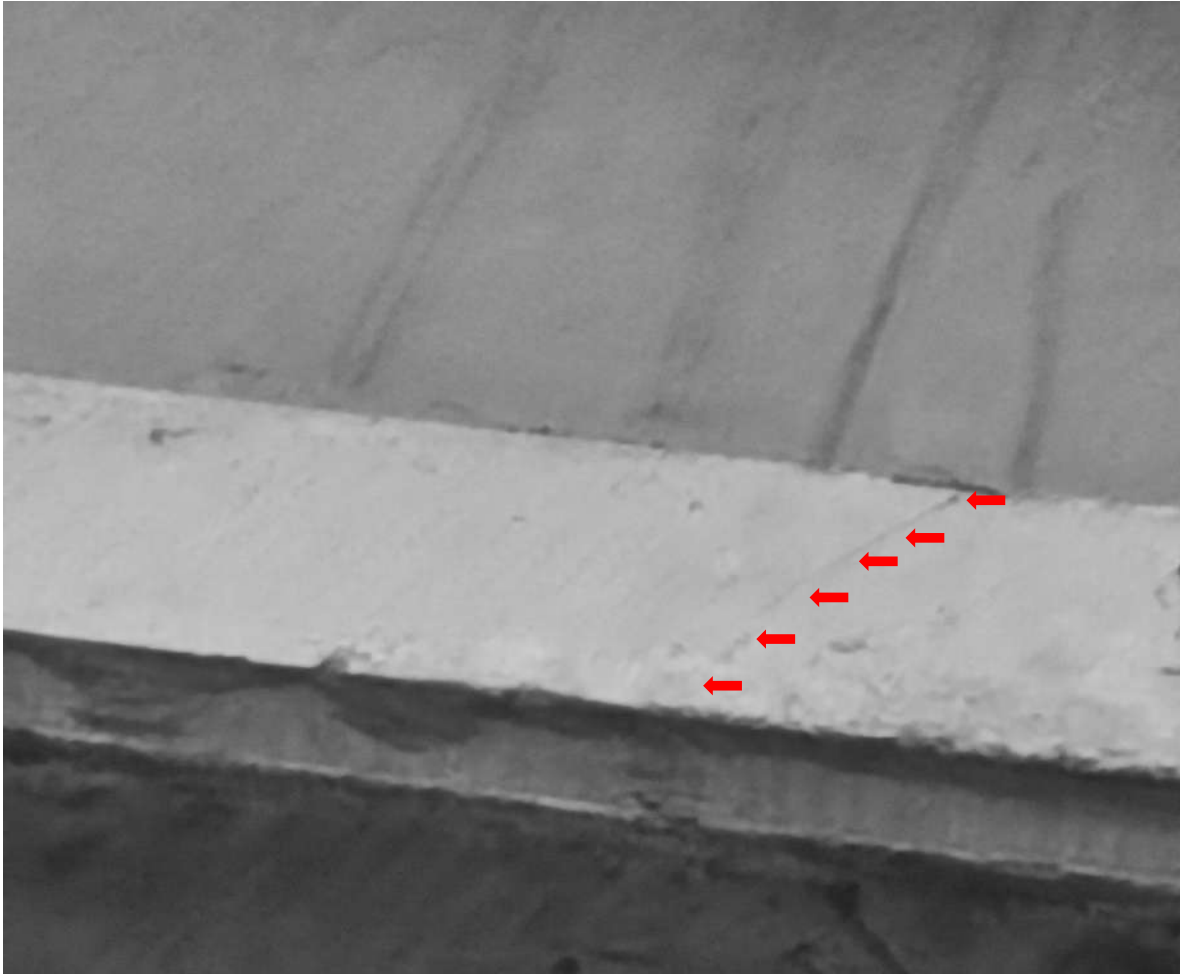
Grietas observadas en trabes ASSHTO tipo IV puente El Lago
